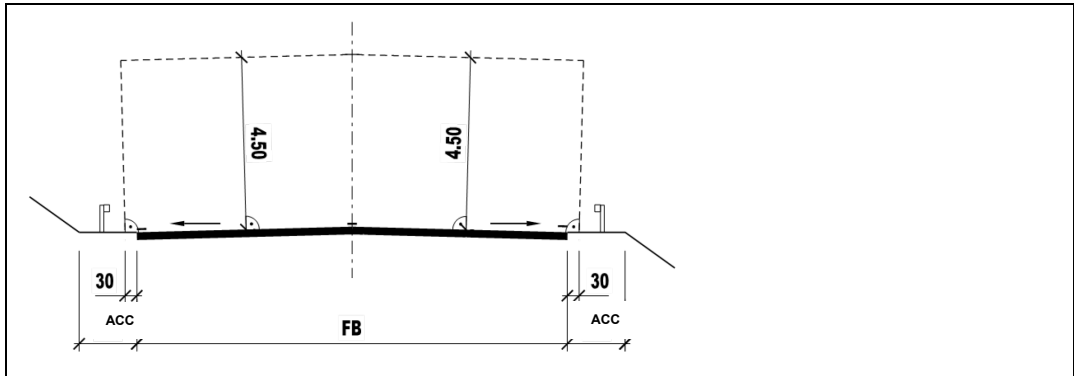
Gabarit d'espace libre sur la section courante (chaussée à 2 voies)
